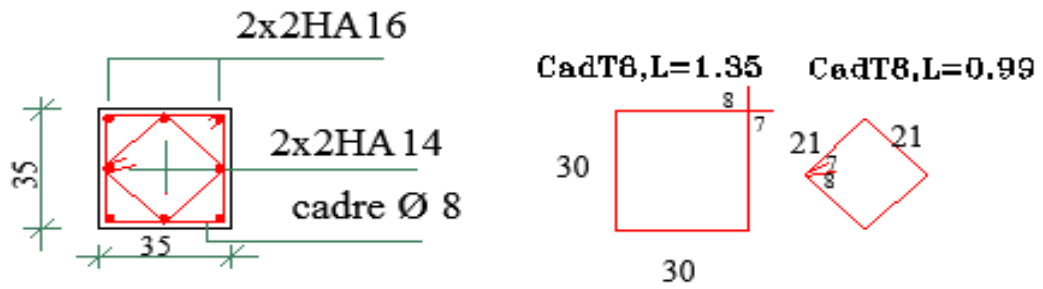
Disposition des armatures dans les poteaux (35x35)
